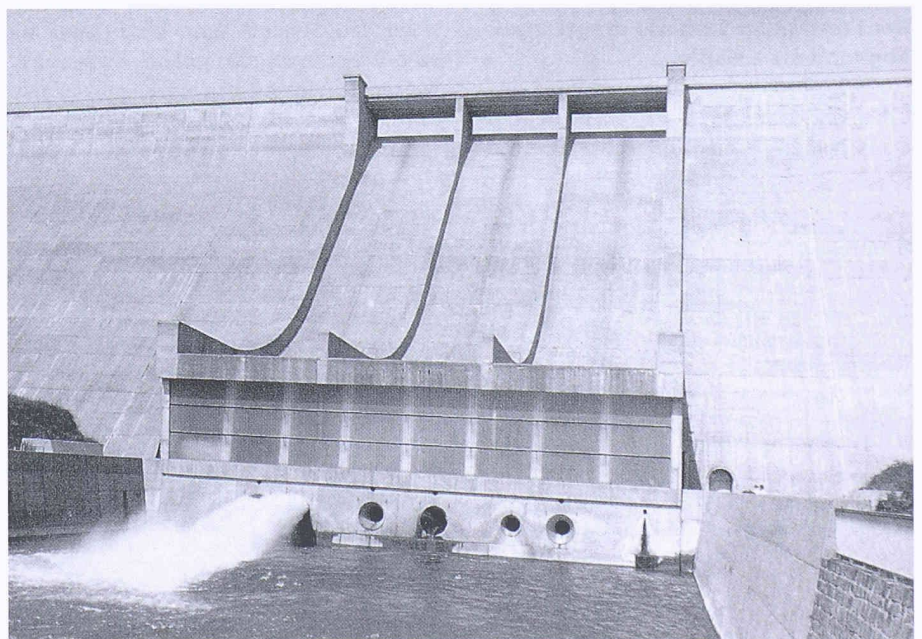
Trinkwasser-Talsperre Eibenstock in Sachsen, Inbetriebnahme 1984, 66 m hohe Betonmauer;
